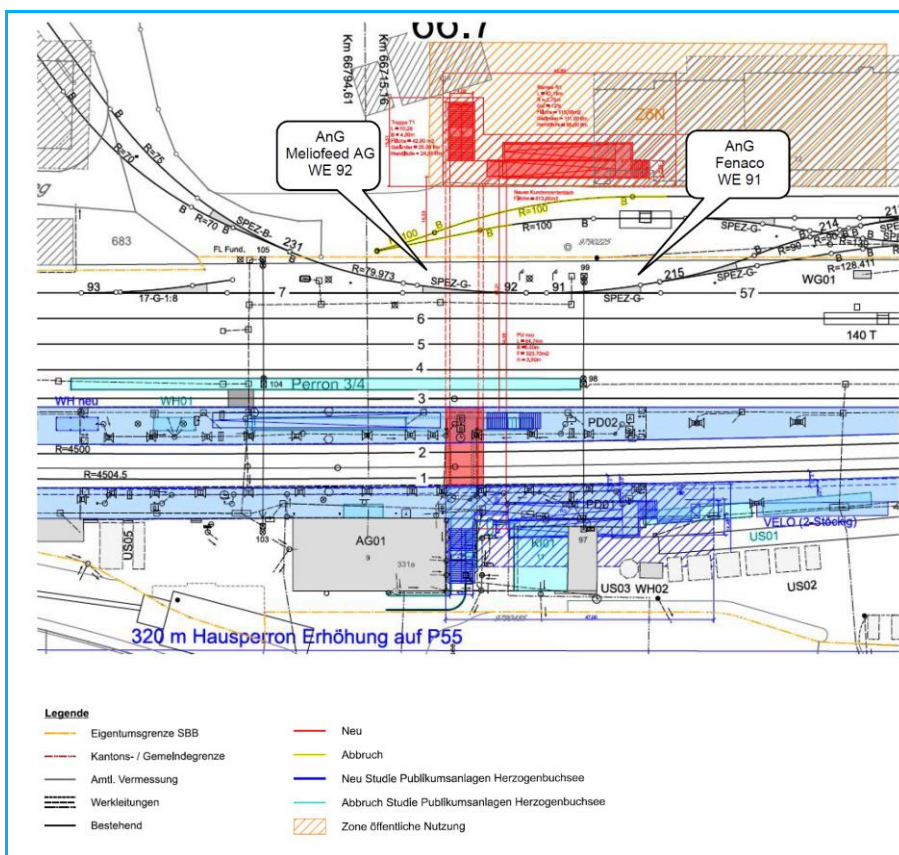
Situationsplan Objektstudie (ohne Massstab) Verlängerung PU mit neuem Bahnzugang West
